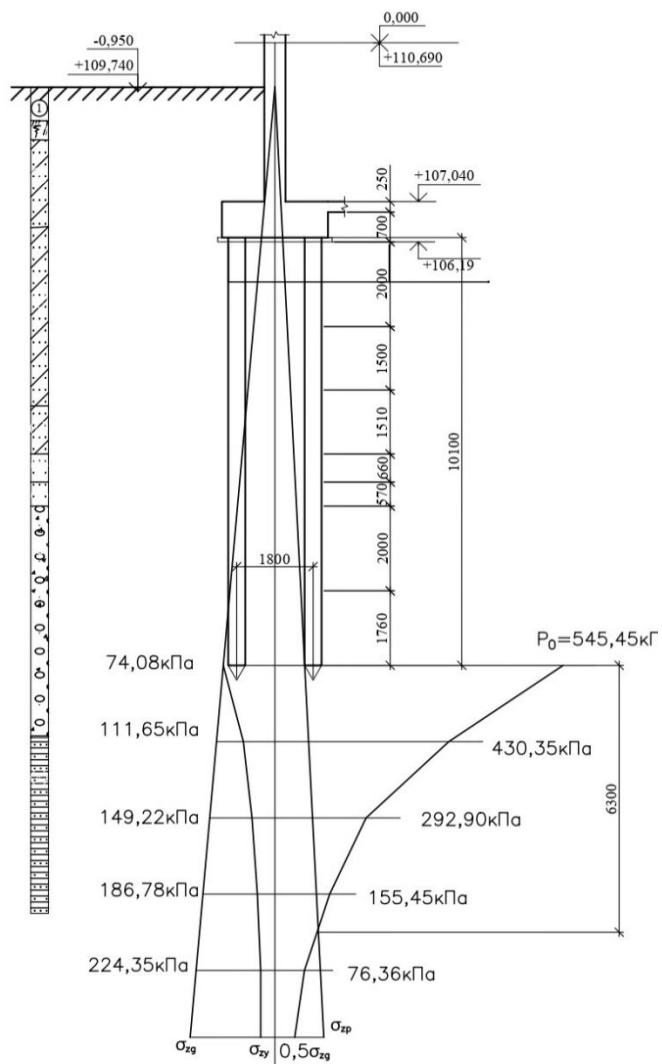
Схема расчета осадки свайного куста (М 1:50)
